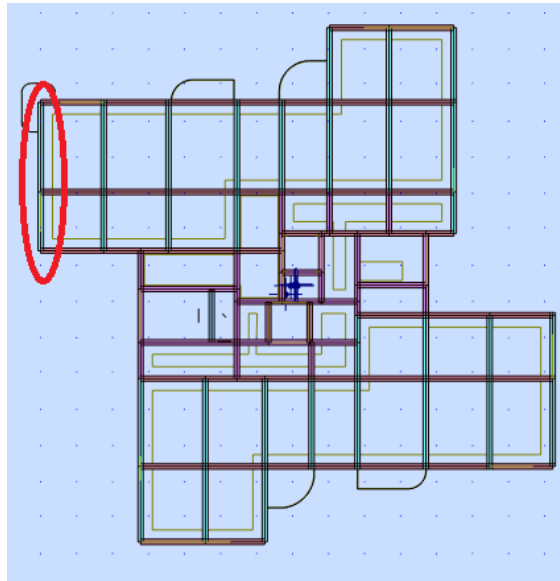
Identification du poutreprincipale de rive calculée
